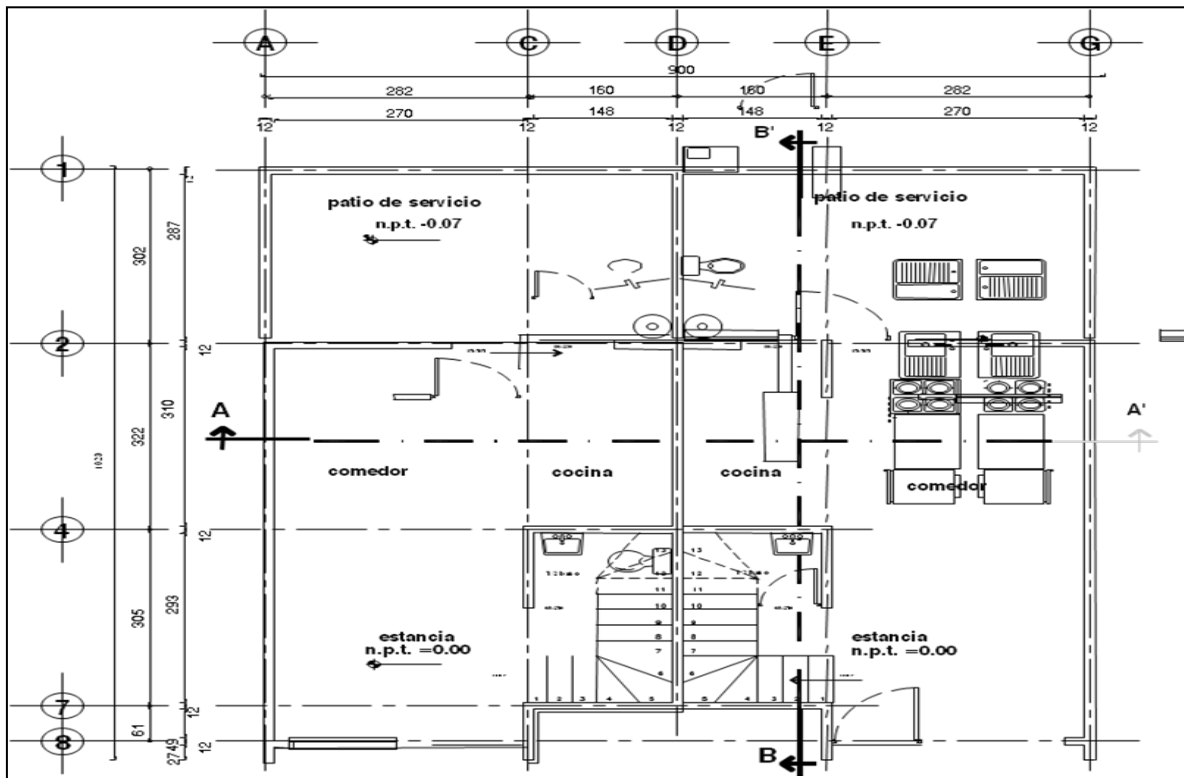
Proyecto arquitectónico (dimensiones a ejes y cotas)
